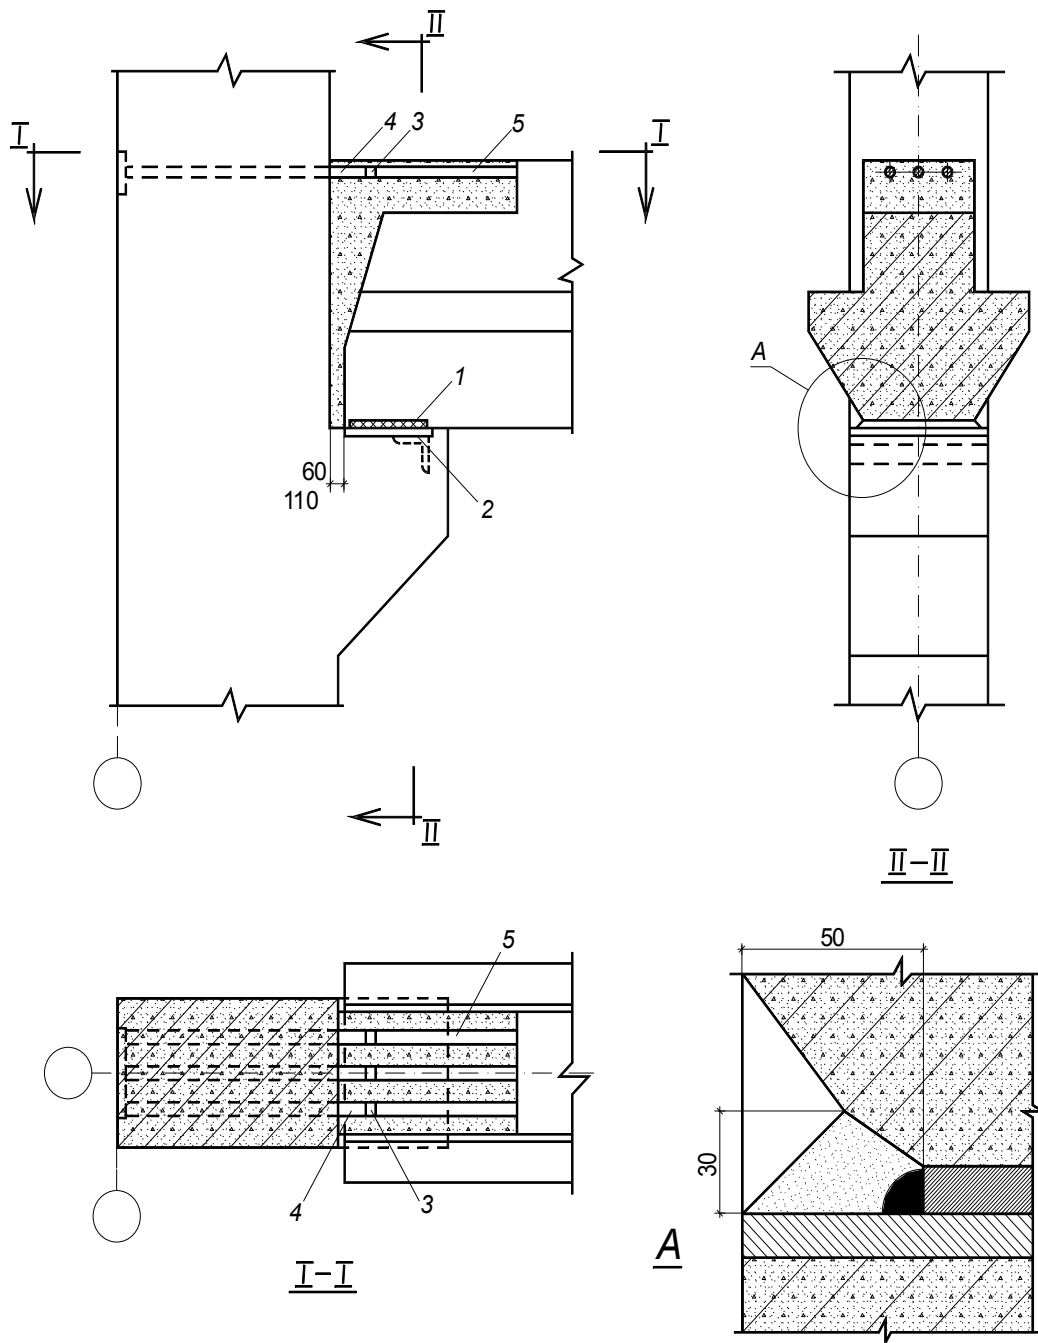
Деталі дотикання ригеля перекриття з крайньою колоною при ригелях з полицями: 1 – закладні елементи ригеля; 2 – закладні елементи колони; 3 – ванне зварювання; 4 – випуск арматури колони; 5 – випуск арматури ригеля
